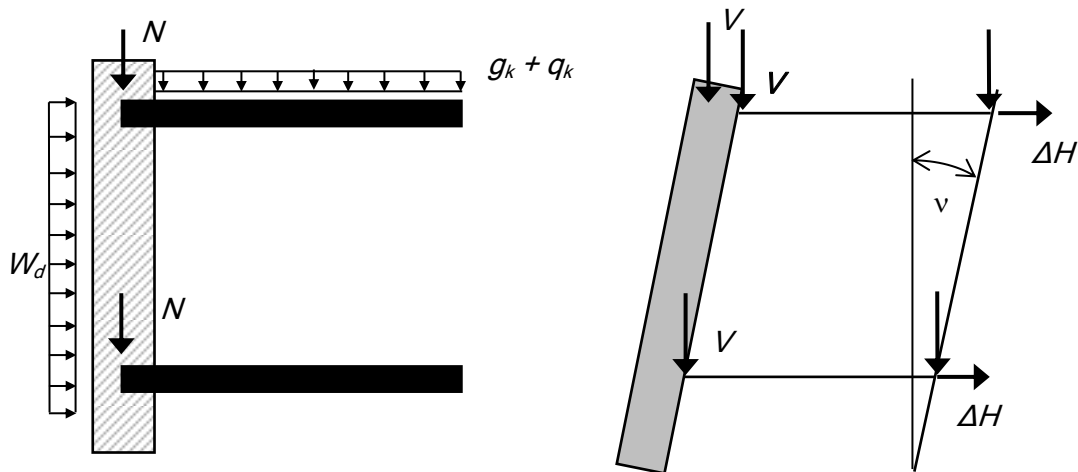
Lotabweichung für den Nachweis der Gebäudeaussteifung
